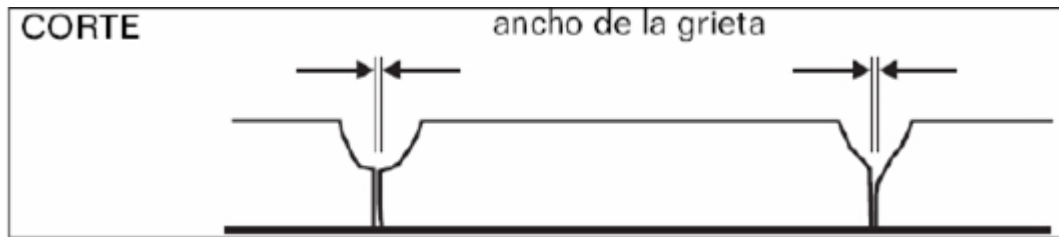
Corte transversal de una losa, mostrando el ancho de una grieta
